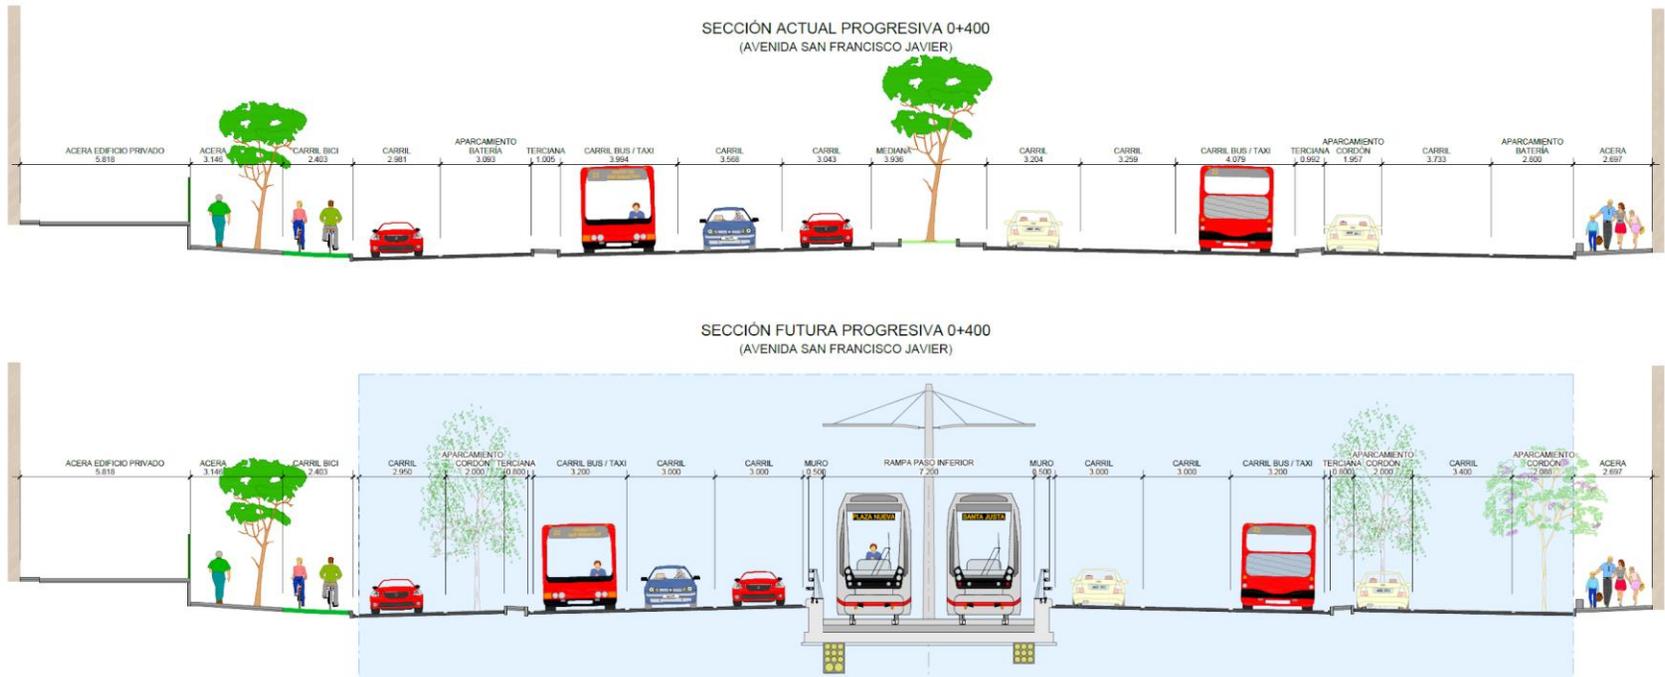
Extracto del proyecto, plano 2.5: alteración de la sección en la Av. San Francisco Javier
